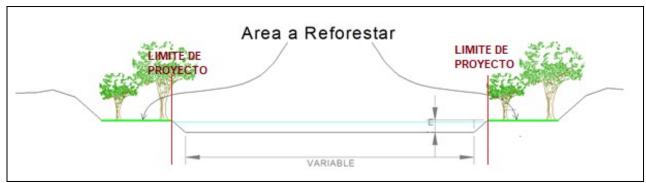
Sección tipo del cauce con el proyecto finalizado.
